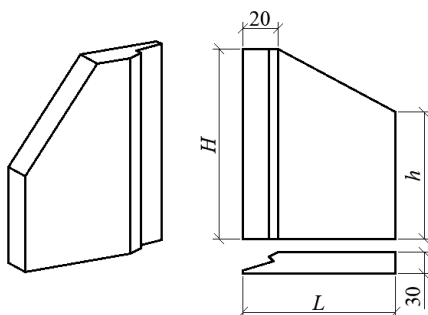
Откосная стенка для бетонной безнапорной раструбной трубы
